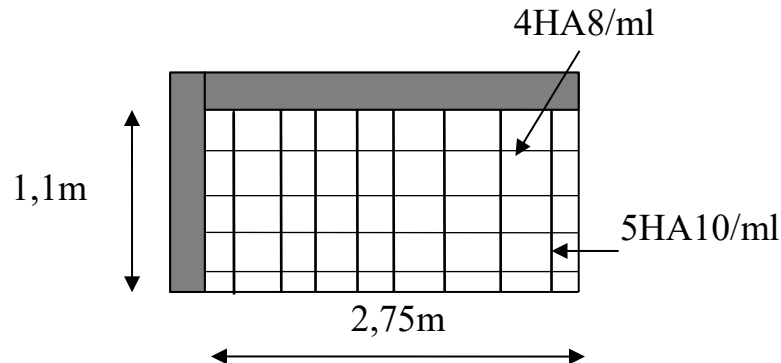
Schéma de ferrailage d'une dalle sur 2 appuis.
